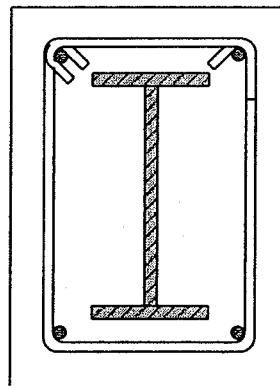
包覆型 SRC 梁之主筋配置示意圖
